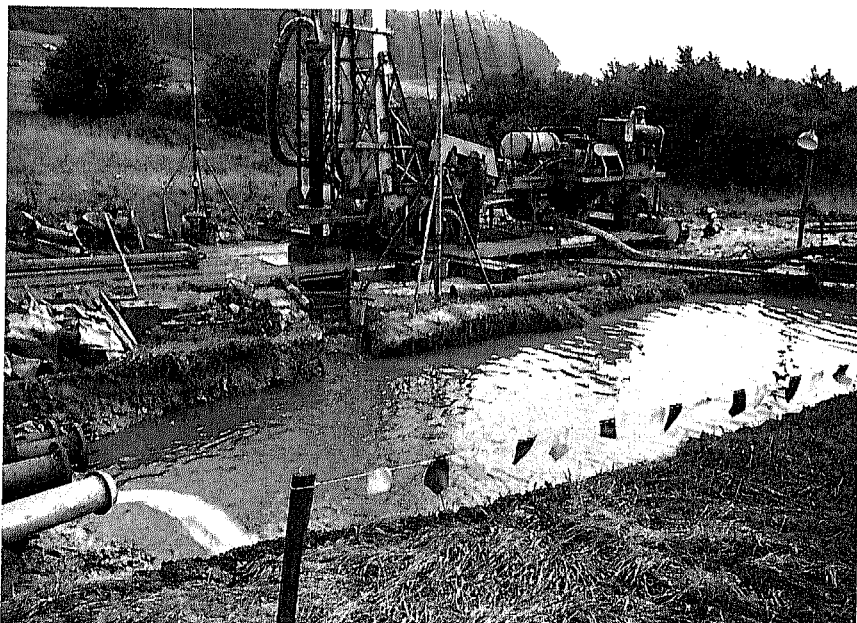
Bohrplatzeinrichtung für die Saugbohranlage SW 200 der Salzgitter Maschinen AG
